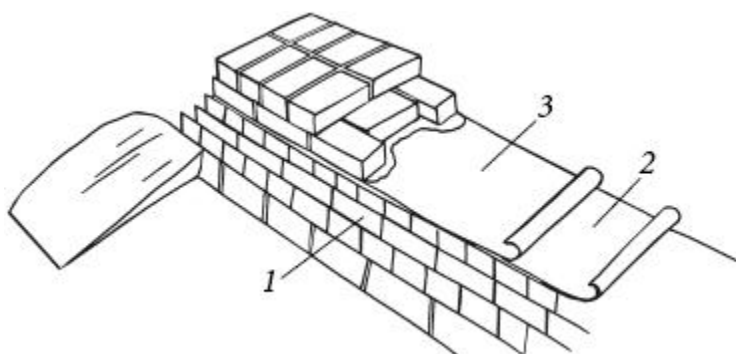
Устройство рулонной горизонтальной гидроизоляции стен: 1) цокольная часть стены ниже «гидроизоляционной» отметки; 2) первый гидроизоляционный слой; 3) второй слой гидроизоляции
